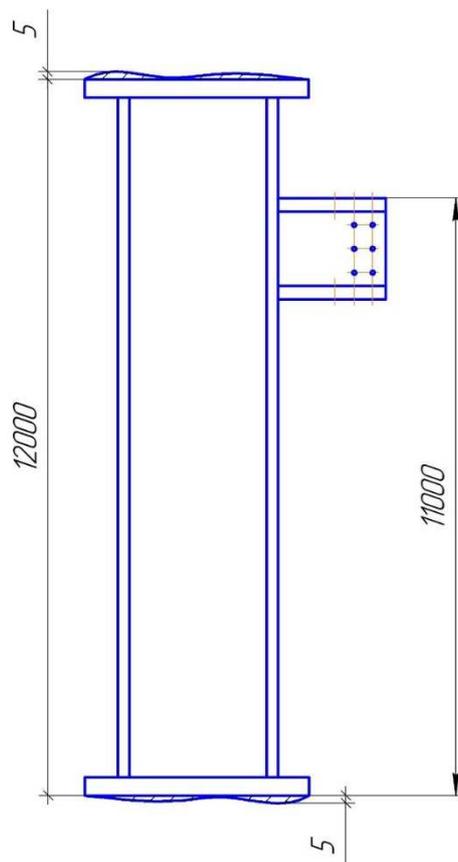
Фрезерование фланцев и установка элементов колонны
